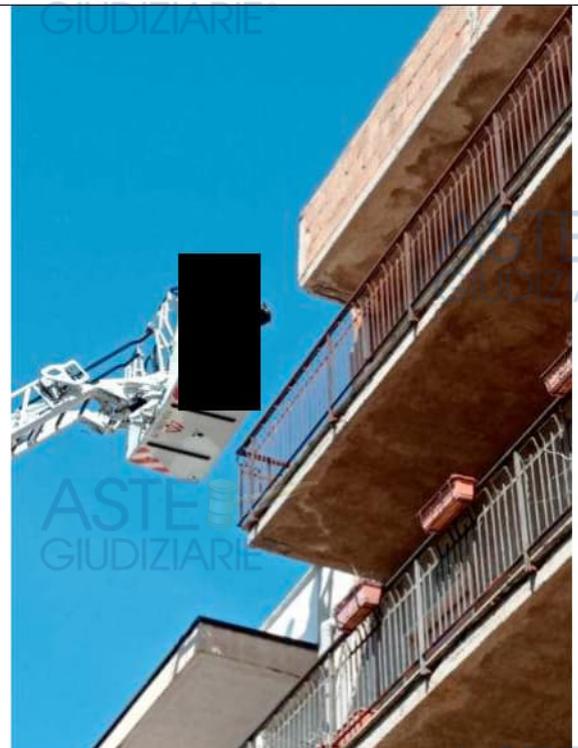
Particolare dell'intervento di messa in sicurezza da parte dei Vigili del Fuoco
